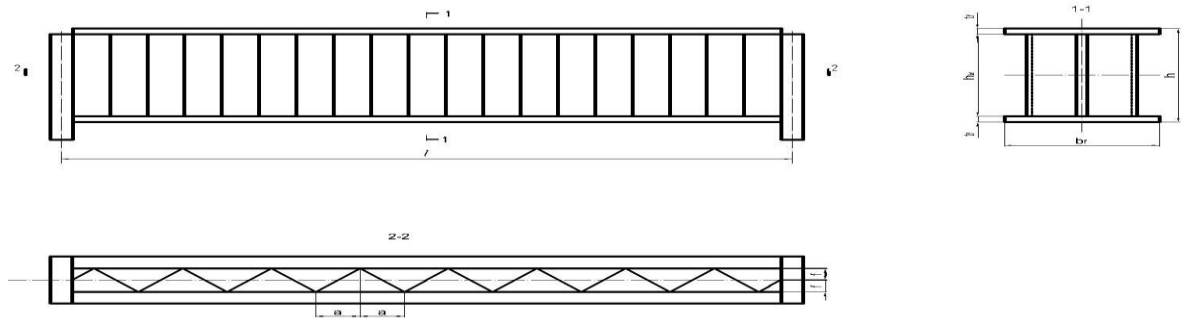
Схема балки с гофрированной стенкой: a – длина полуволны гофра; f – высота волны гофра; h – высота сечения балки; h_w – высота сечения стенки; t_w – толщина сечения стенки; b_f – ширина сечения пояса; t_f – толщина сечения пояса
